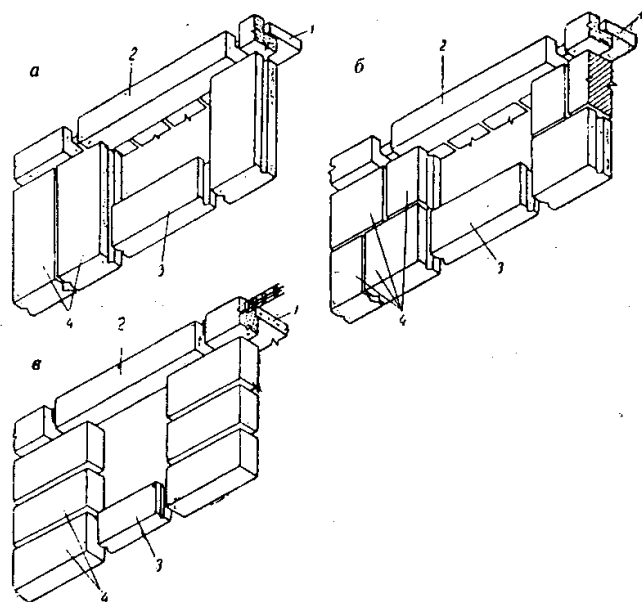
Фрагмент наружной стены из крупных блоков:
